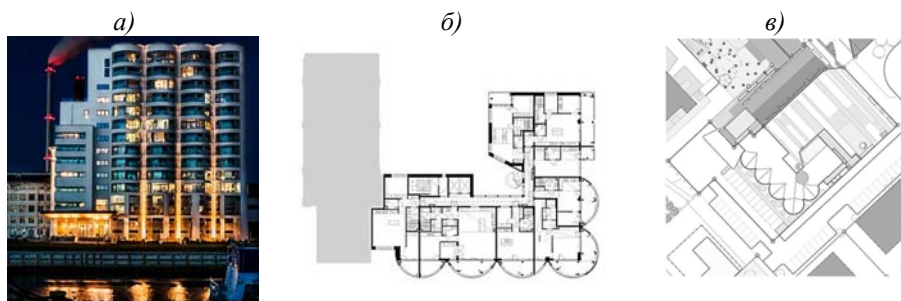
Железобетонный зерновой силосный корпус: *а* – внешний вид; *б* – типовой план здания; *в* – генеральный план участка
